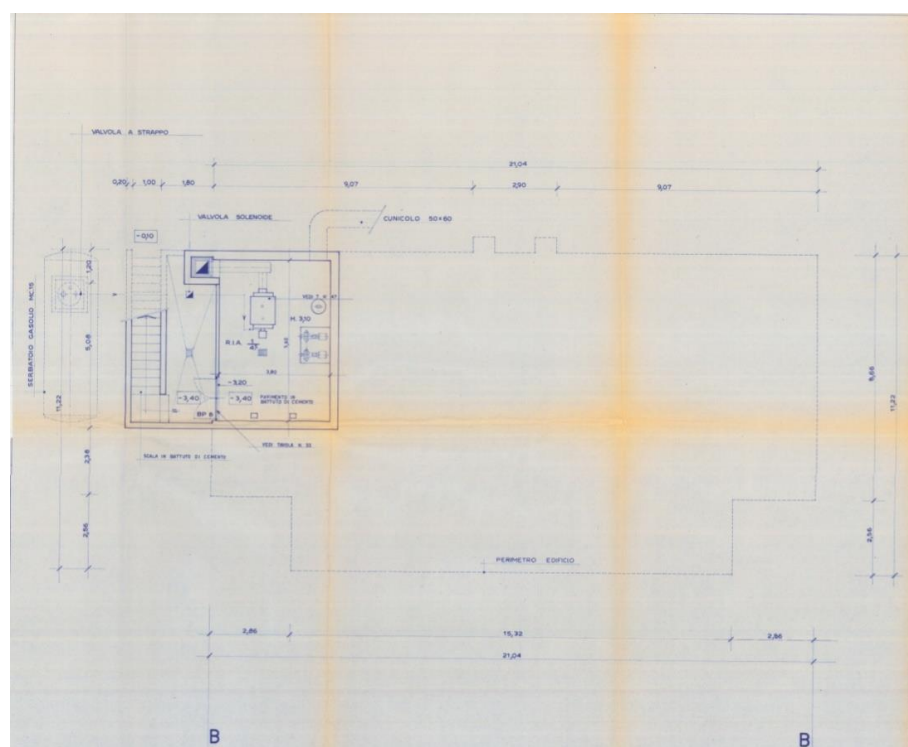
, Pianta locale caldaia, scansione progetto originale
